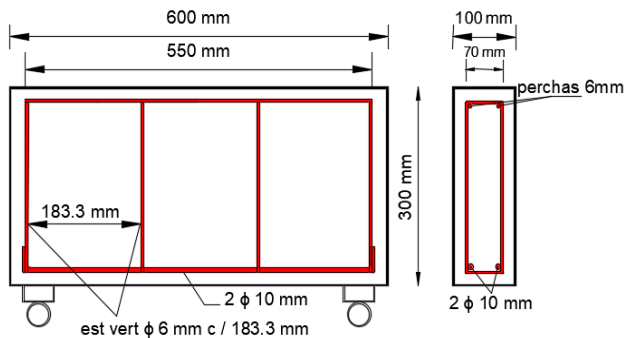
Geometría y detalle de armado de especímenes con armadura a corte reducida
